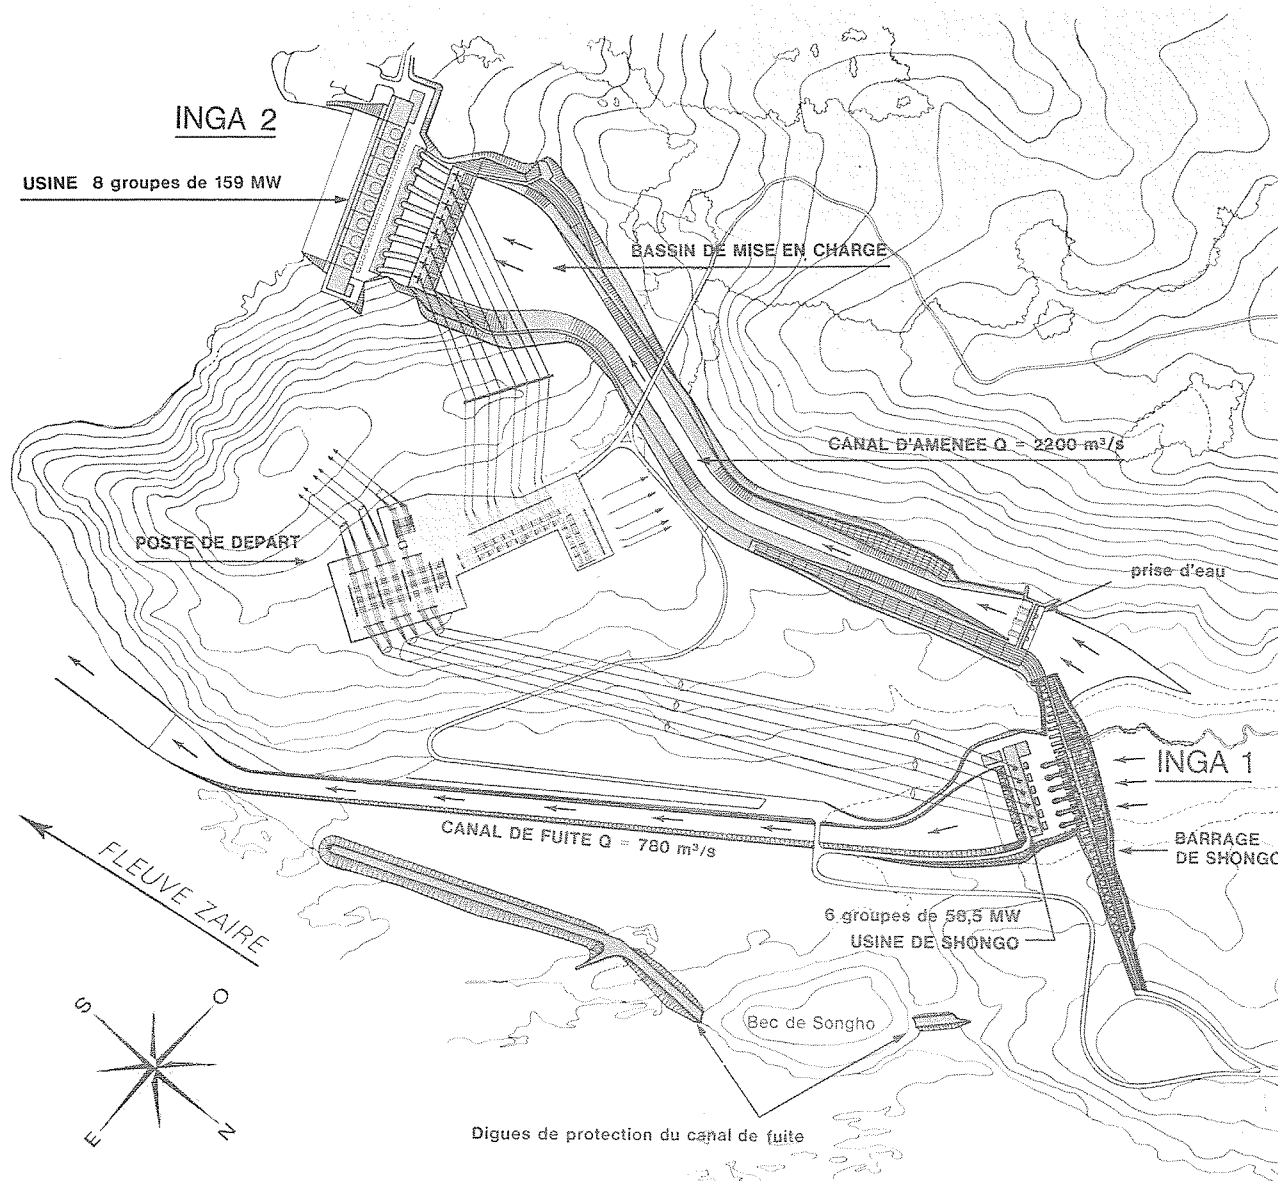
Plan des ouvrages aval Inga 1 et 2.
